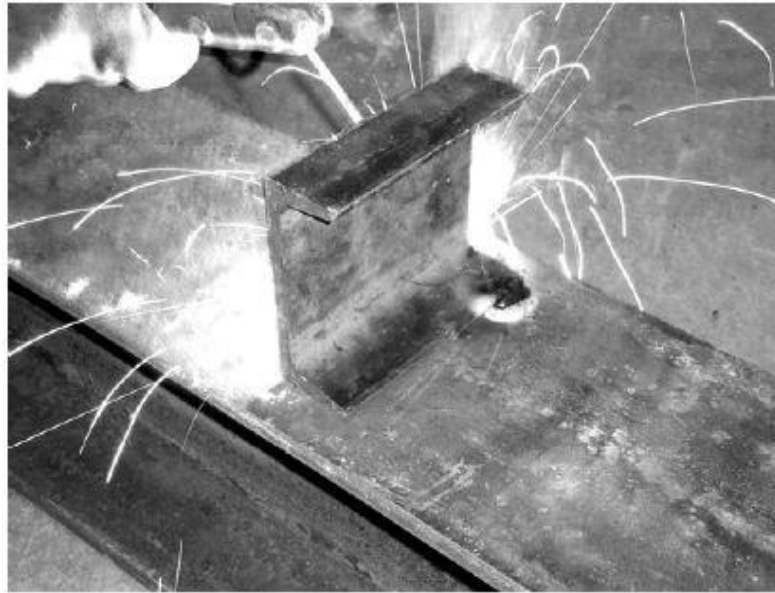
Soudure d'un connecteur en U. [21]
